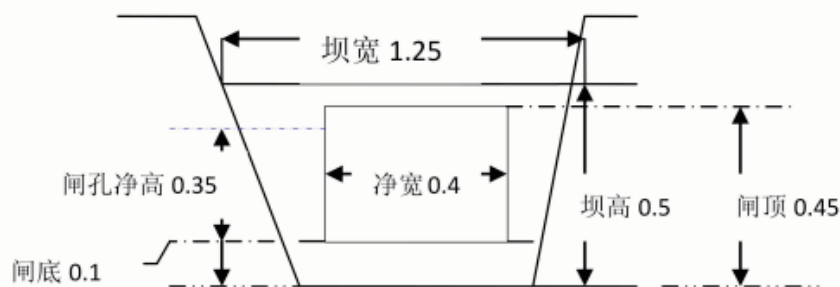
节制闸坝断面示意图（单位：m）
